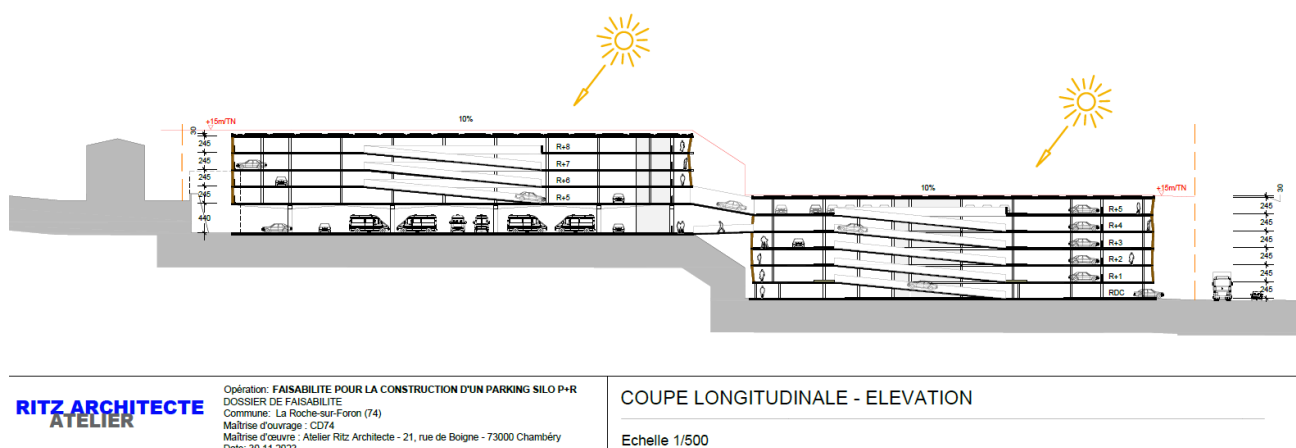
Coupe longitudinale du parking en silo (Source : Ritz Architecture)
